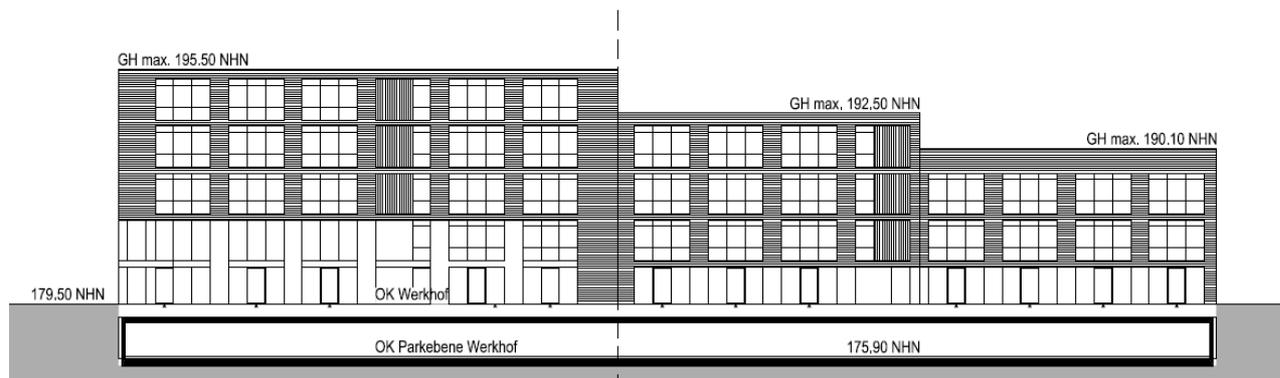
Gebäudeschnitt Bereich westlich Werkhof - Entwurf, Stand 15.06.2022
